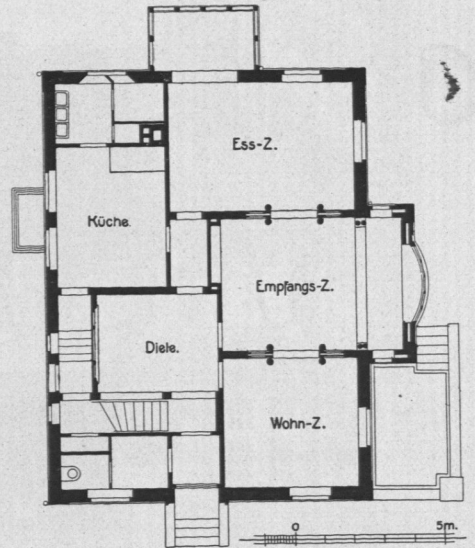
Landhaus Lindhorst, Hochkamp, Erdgeschoss.
